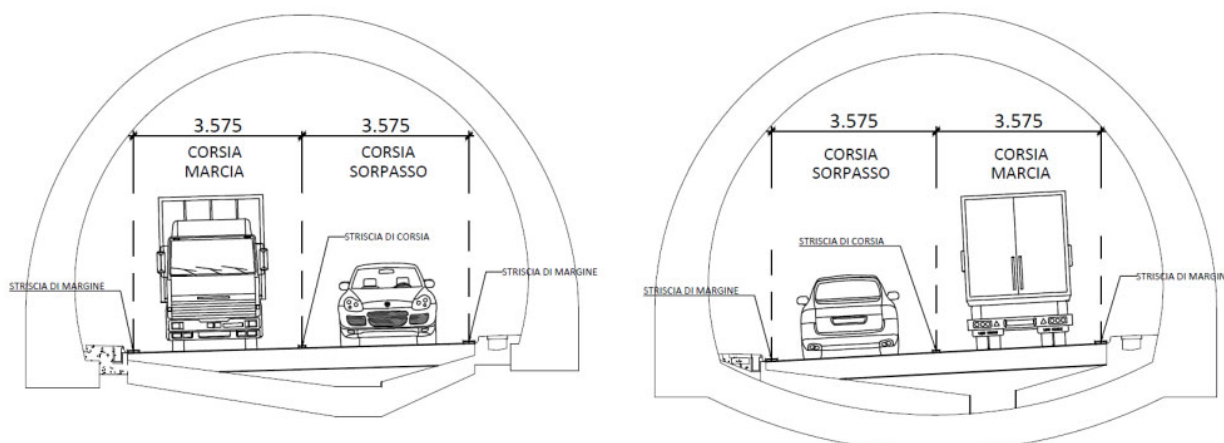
Schema dell'attuale configurazione stradale in galleria.
